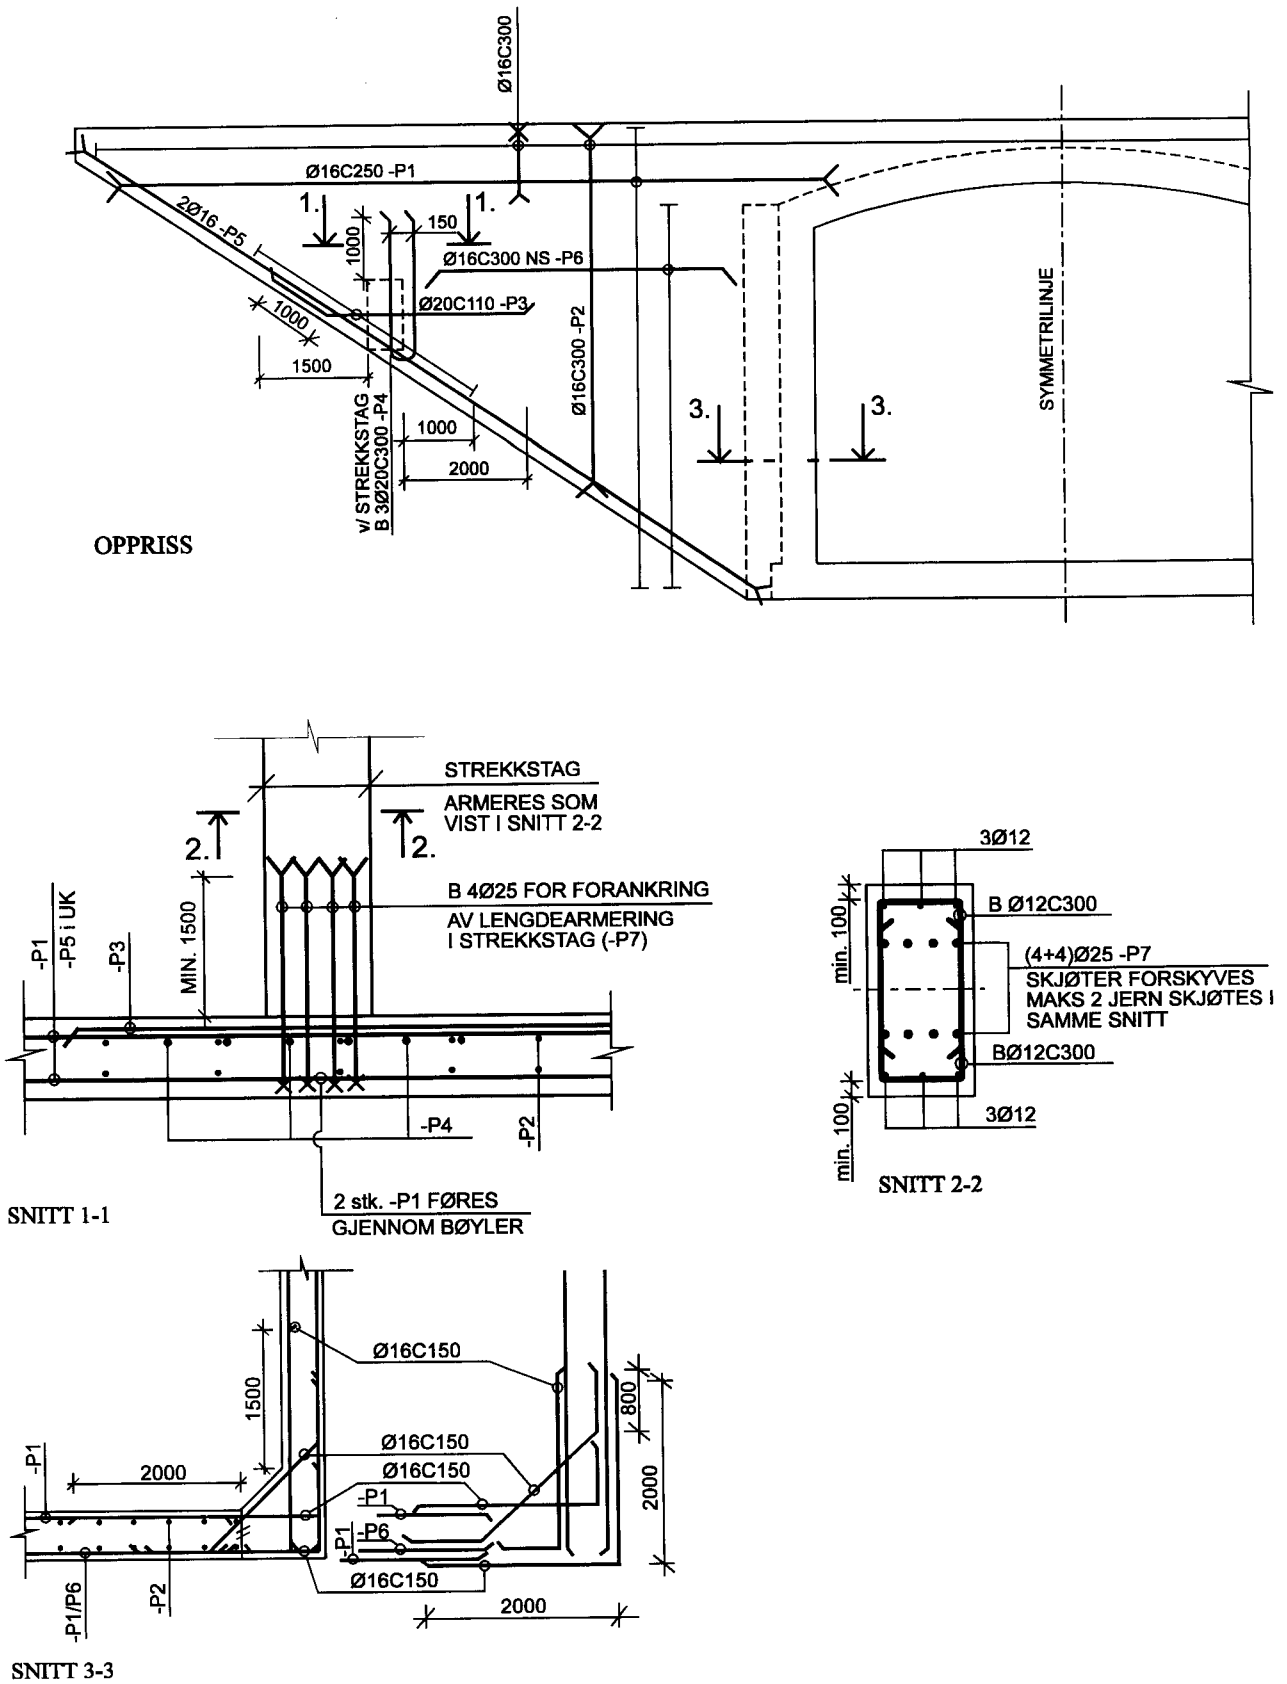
Vingemur normalt på kulvertvegger for kulvert type 2,3 og 4. Armering
